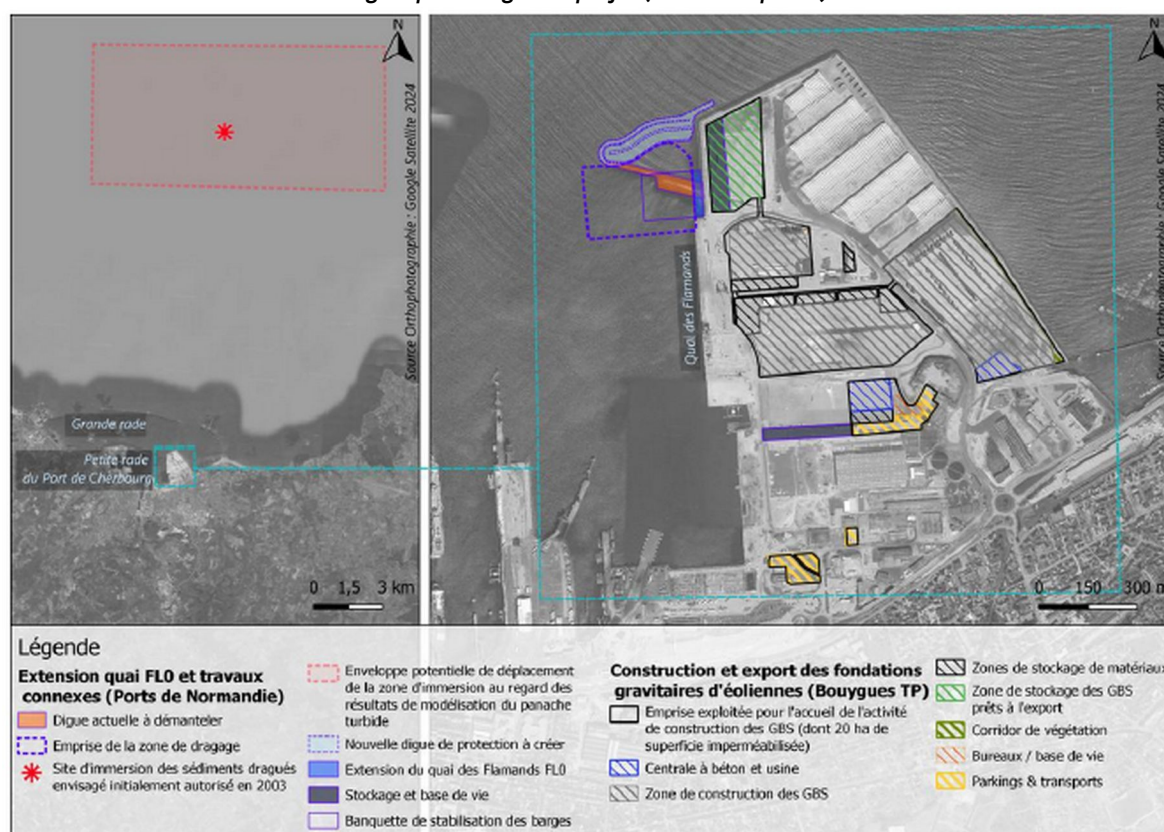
Dispositions constructives globales (source : planche 35, p. 39 du document « plans et figures »).
